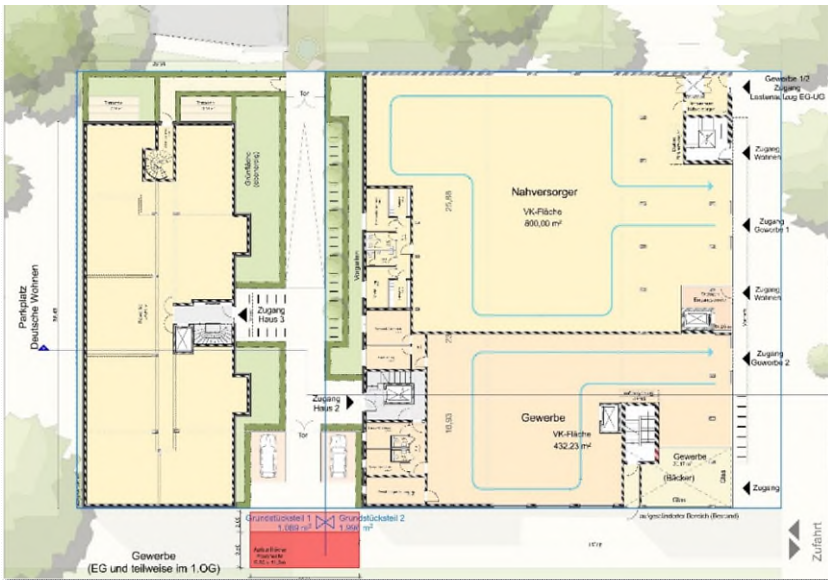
Um- und Neubau Wohnstandort 'Halemweg 17-19': EG-Grundriss mit Freianlagen, Stand: 26.11.2021
